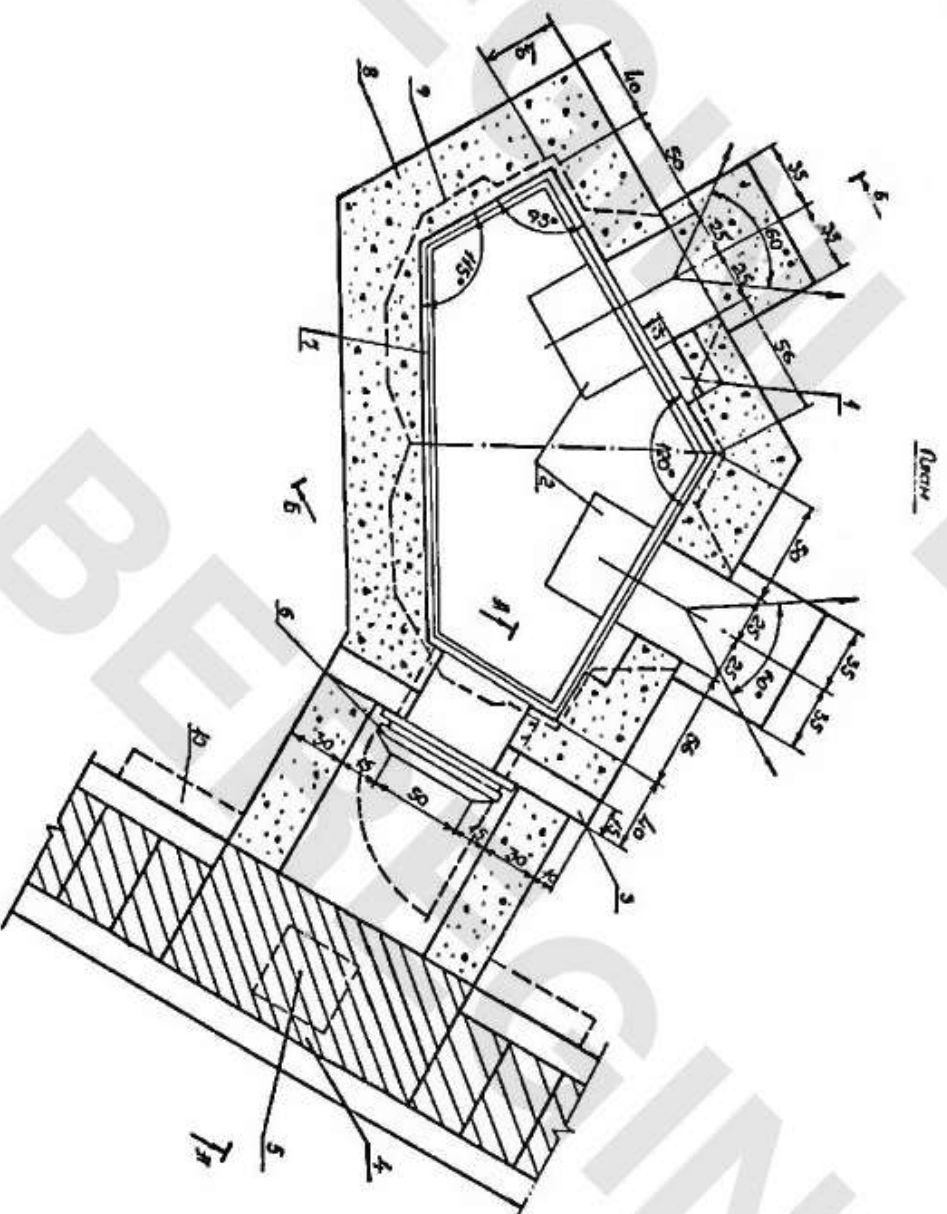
Кулеметна споруда із закриттям СПМ-1М з основою із бетону (план):
